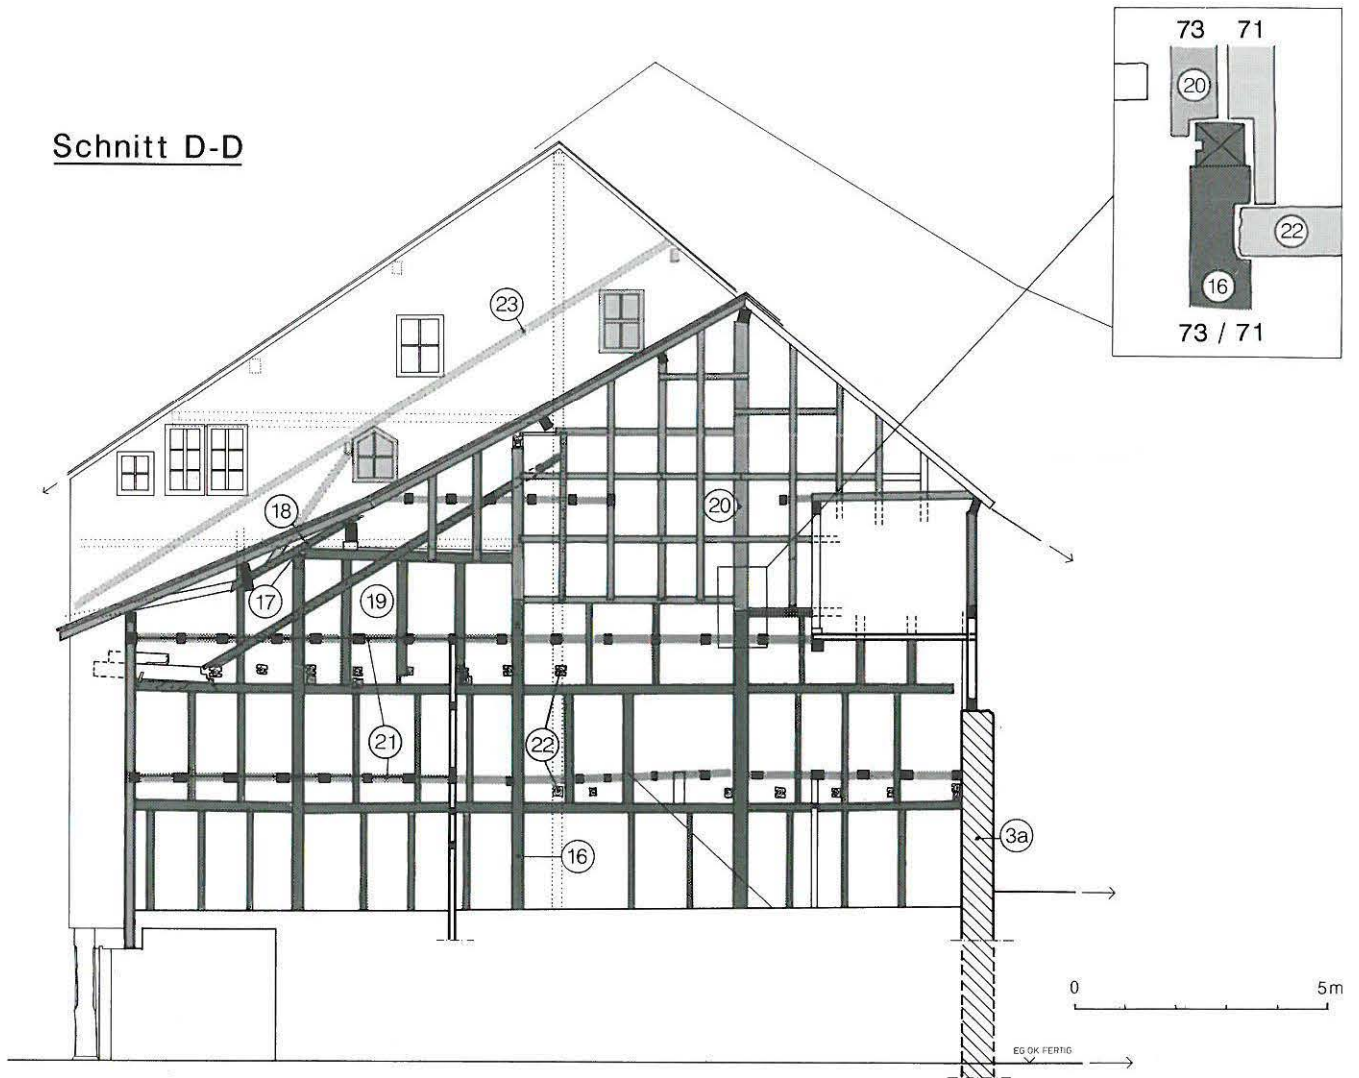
Bälliz 73. Mittlere Brandmauer nach Westen. M. 1:150. Signaturen s. Abb. 2. 2b Mauerrest, 16 Ständerkonstruktion Bälliz 71/Erweiterungsetappe II, 17 Gefaster Balkenkopf, 18 Dachsparren Bälliz 71, 19 Langstrebe, 20 Ständerwerk Bälliz 73/Erweiterungsetappe IV, 21 Balkenlagen zu Bälliz 73/Erweiterungsetappe IV, 22 Balkenköpfe von Bälliz 71/Erweiterungsetappe III, 23 Dachlinie Bälliz 71/Erweiterungsetappe III.
